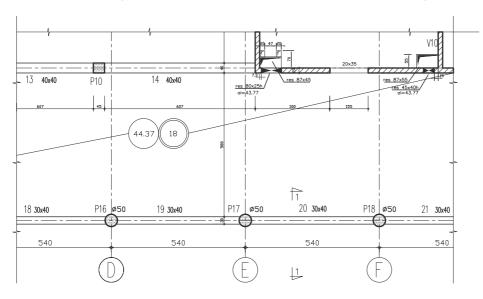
plan de coffrage du plancher haut du RDC, cotation en cm
